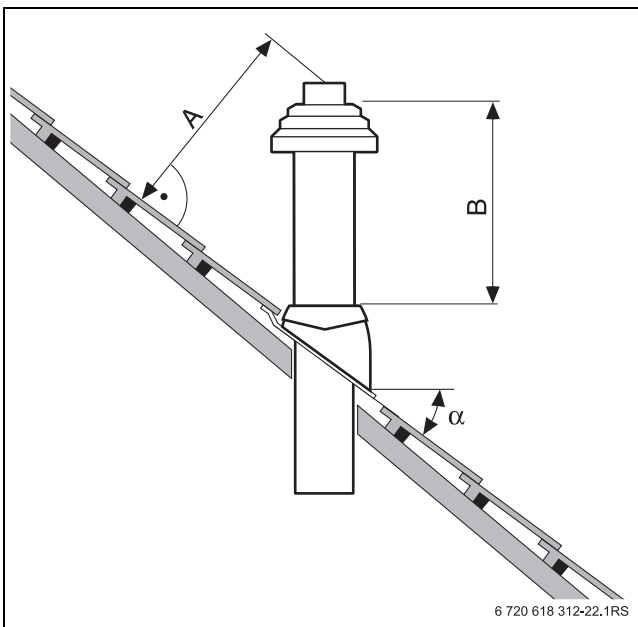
Abstandsmaße und Dachneigungen bei Schrägdach
